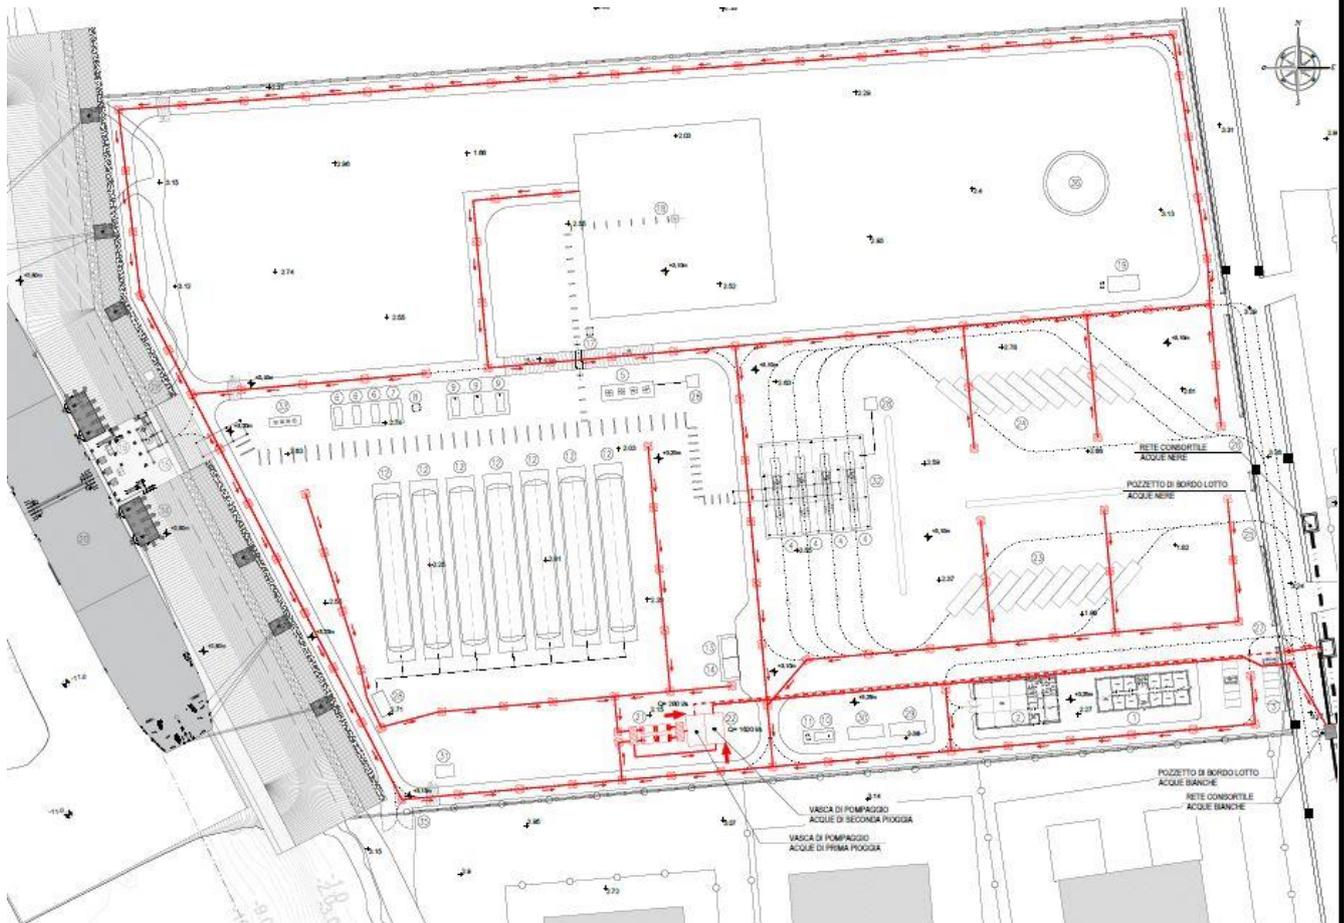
Planimetria rete di smaltimento acque meteoriche
